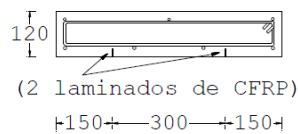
Seção transversal das lajes de betão armado reforçadas, usando a técnica NSM, com laminados de CFRP (Hosseini *et al.*, 2014) (dimensões em mm).
